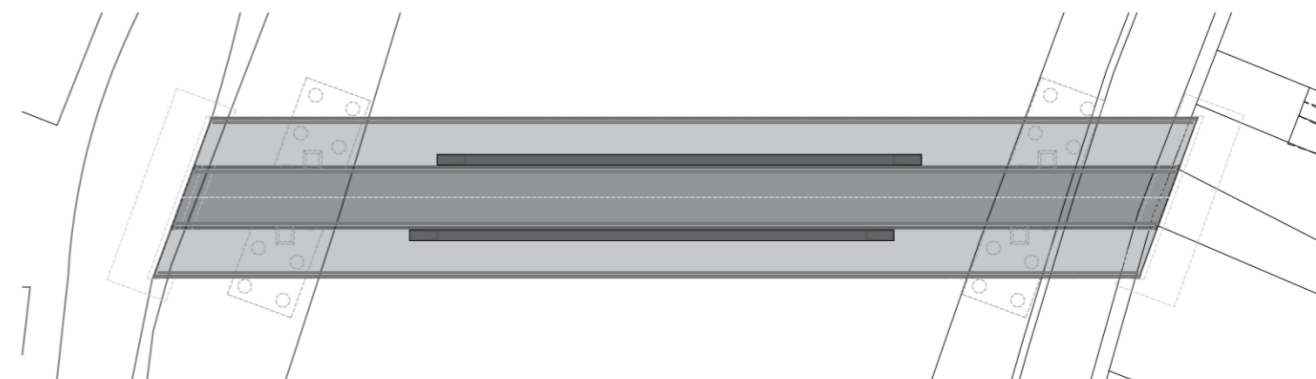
Vista en planta del puente (fuente: elaboración propia)
